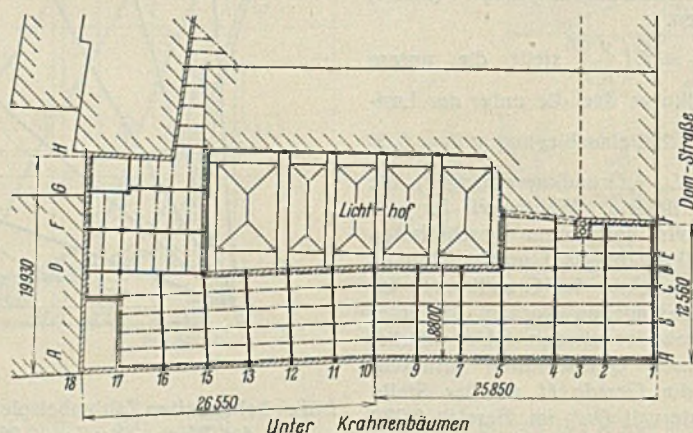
Grundriß und Lageplan des Erweiterungsbaues.
